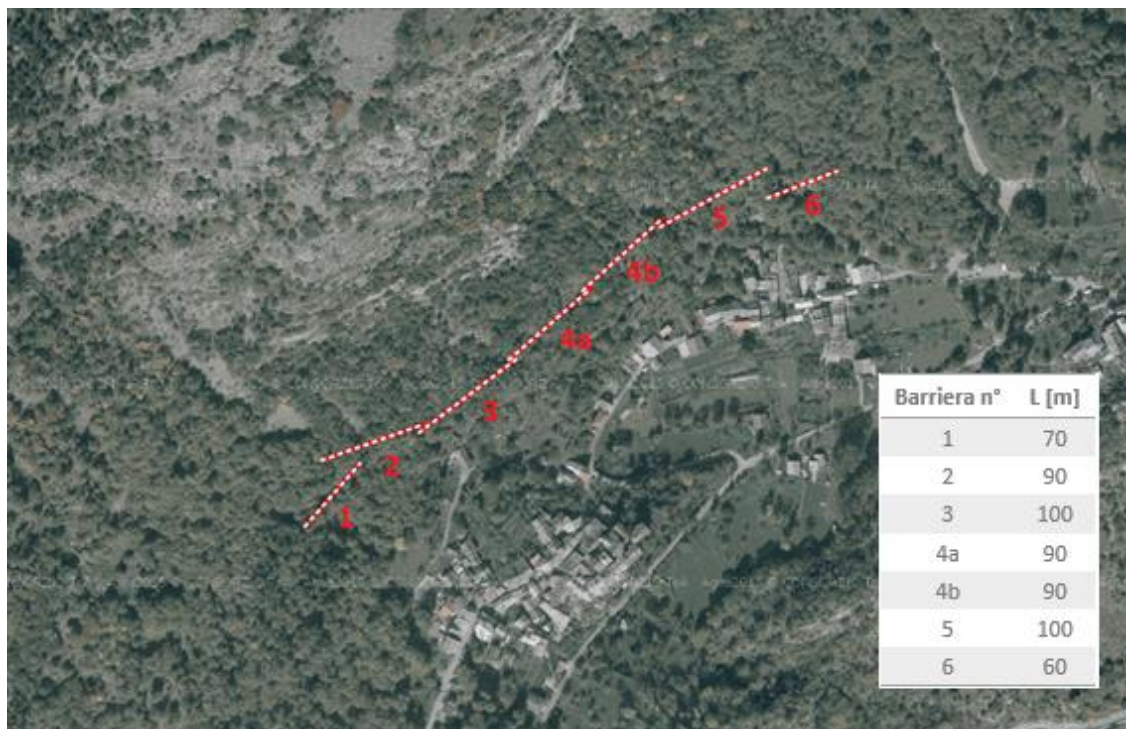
Disposizione planimetrica definitiva delle barriere paramassi progettate (QGIS 2.18.28)
